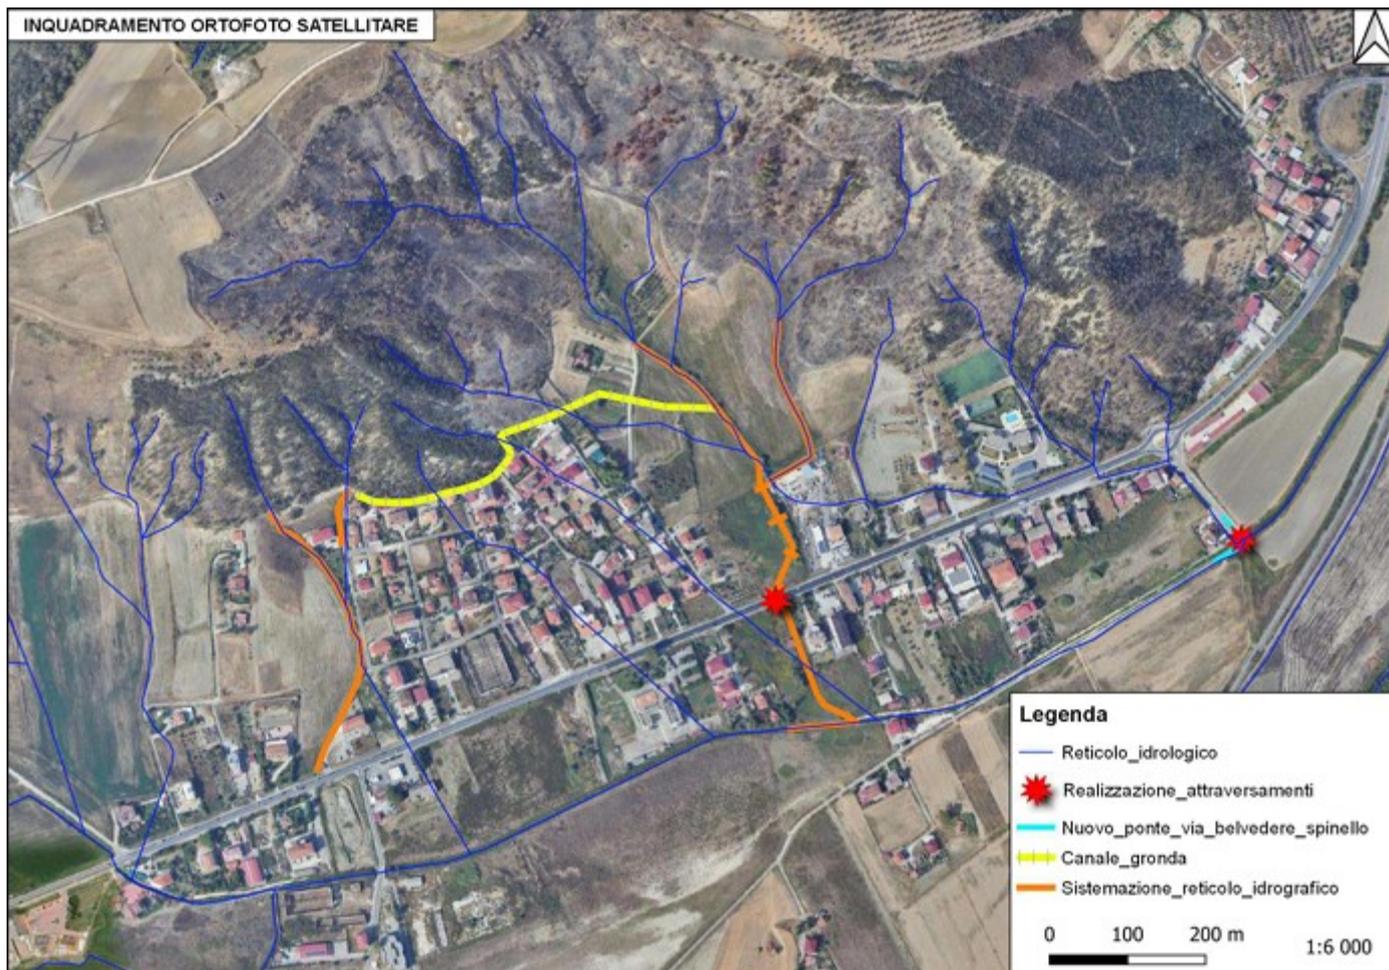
Planimetria generale degli interventi su ortofoto satellitare
